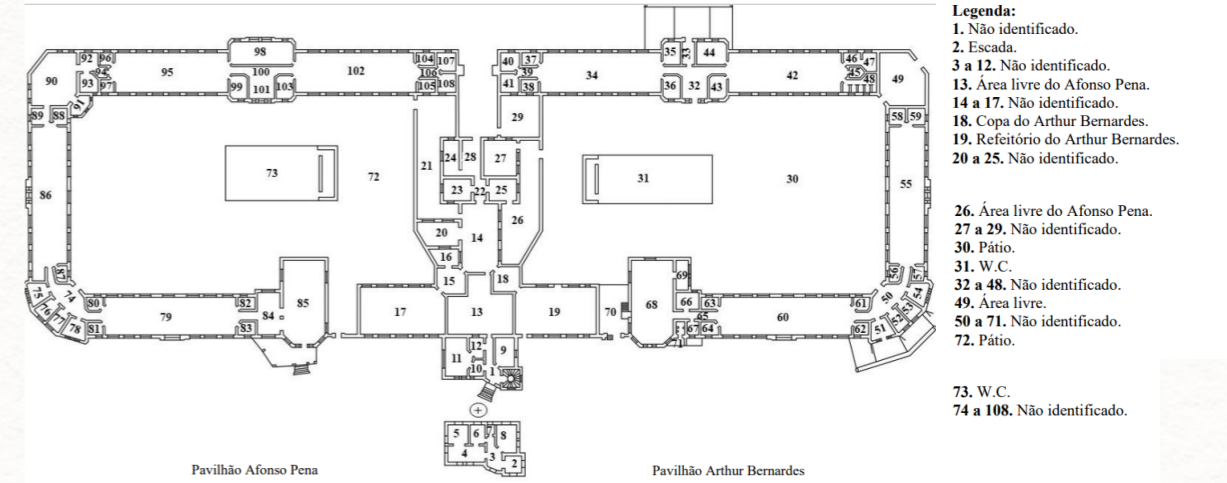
Planta baixa dos pavilhões Afonso Pena e Arthur Bernardes da Colônia de Barbacena Fonte: Moreira, 2021, p.180.
